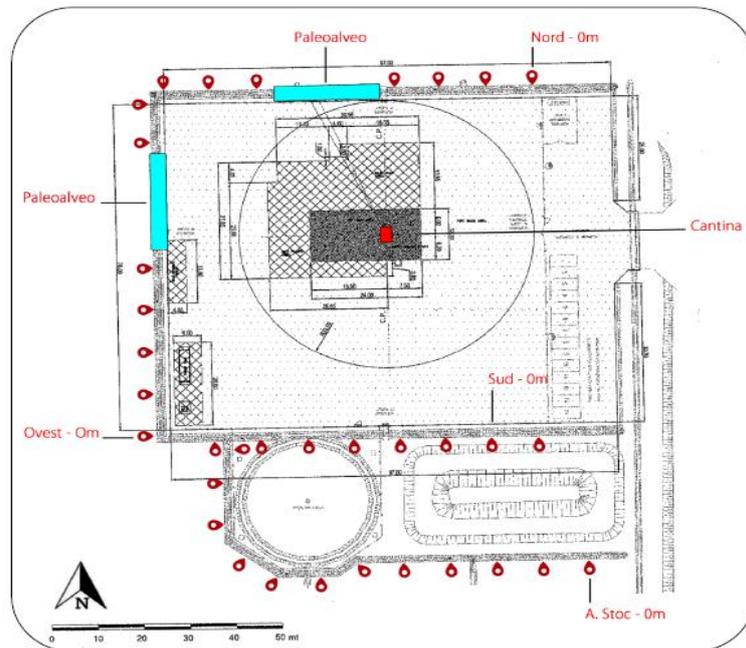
r: Localizzazione delle Sezioni rispetto alla Postazione del Pozzo Trava-2 dir (Excogita 2016)
